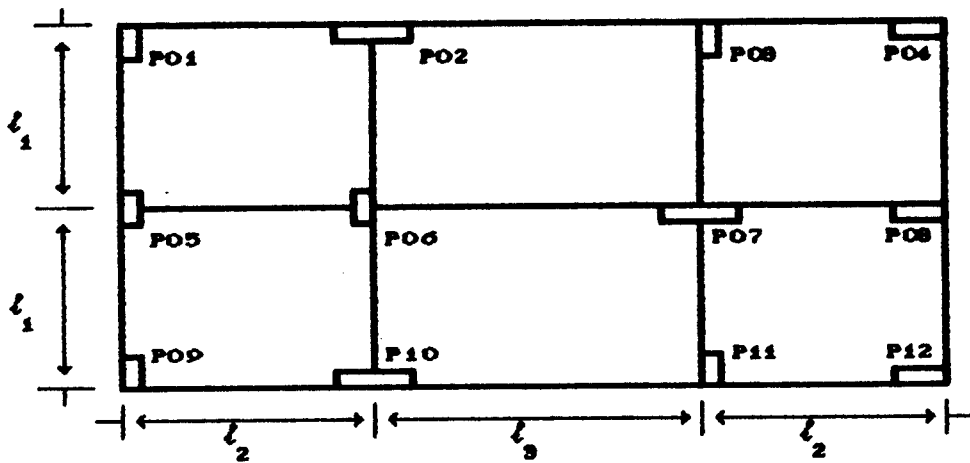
Planta de formas simplificada do pavimento-tipo.
